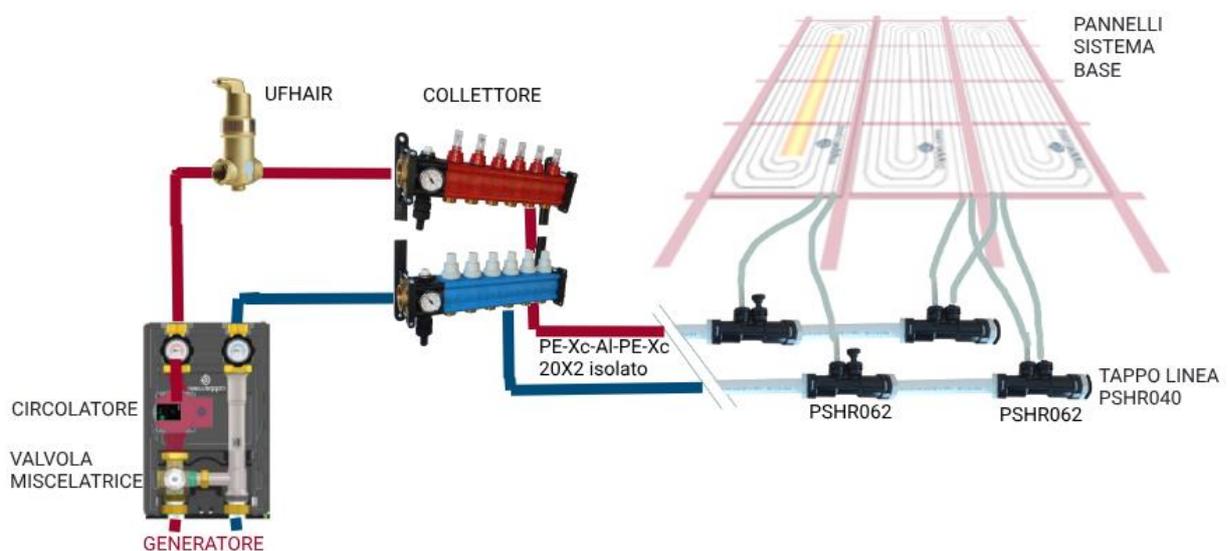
Schema esemplificativo di collegamento impianto radiante a soffitto
